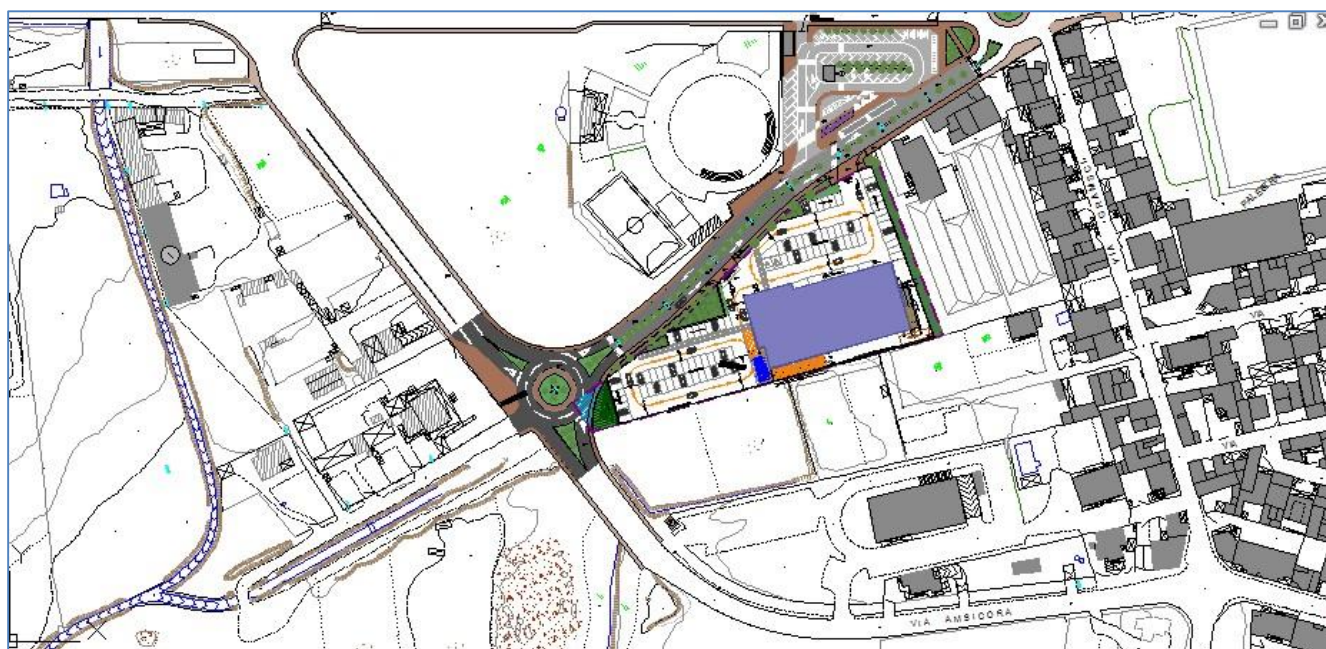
stralcio della planimetria delle opere di urbanizzazione.
